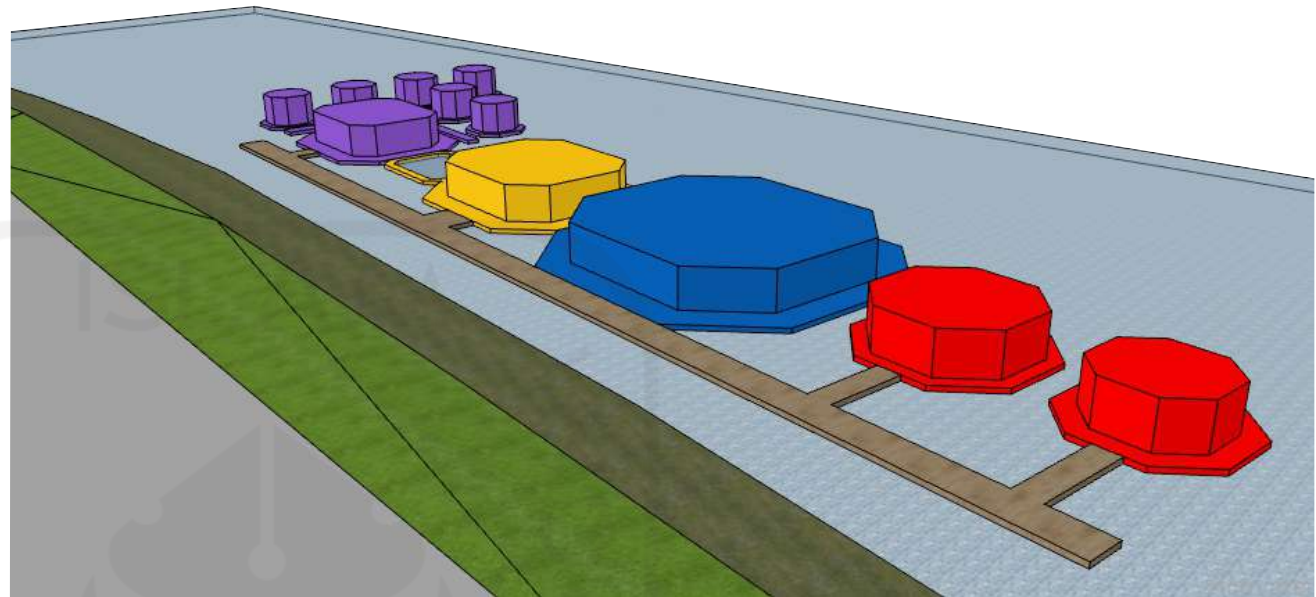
Eksplorasi Gubahan Alternatif 3
